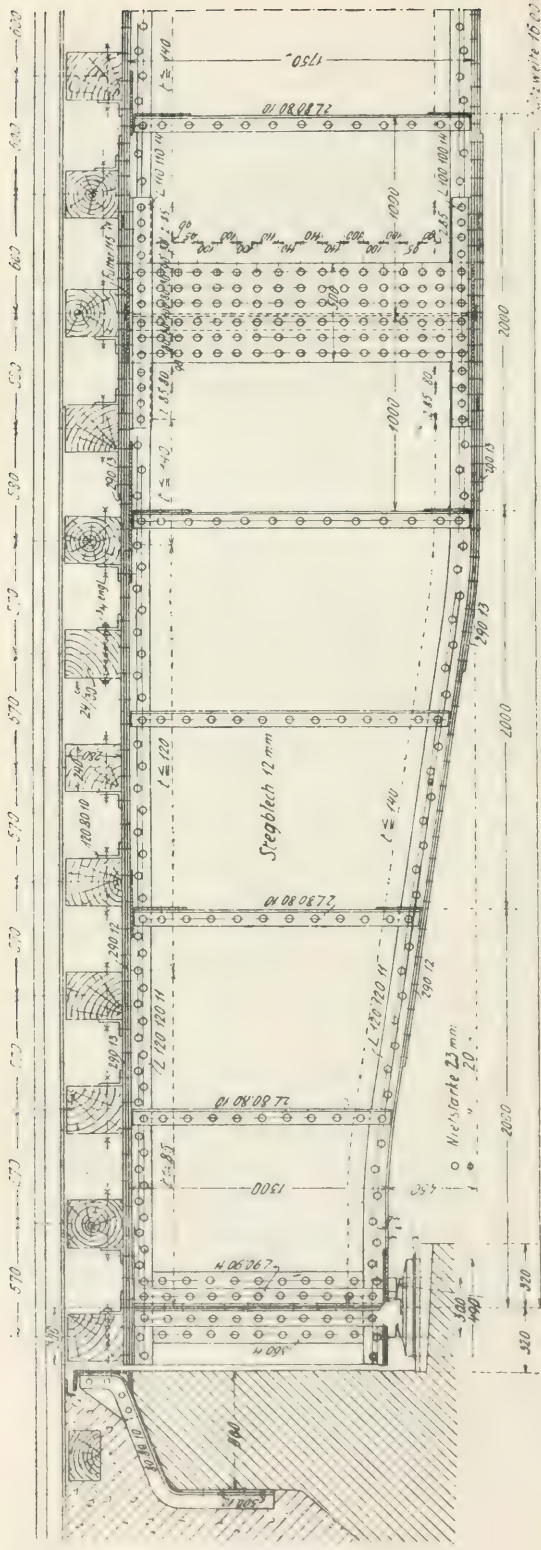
a, b. Eisenbahn-Blochbrücke mit Bahn oben, für 16 m Stützweite
